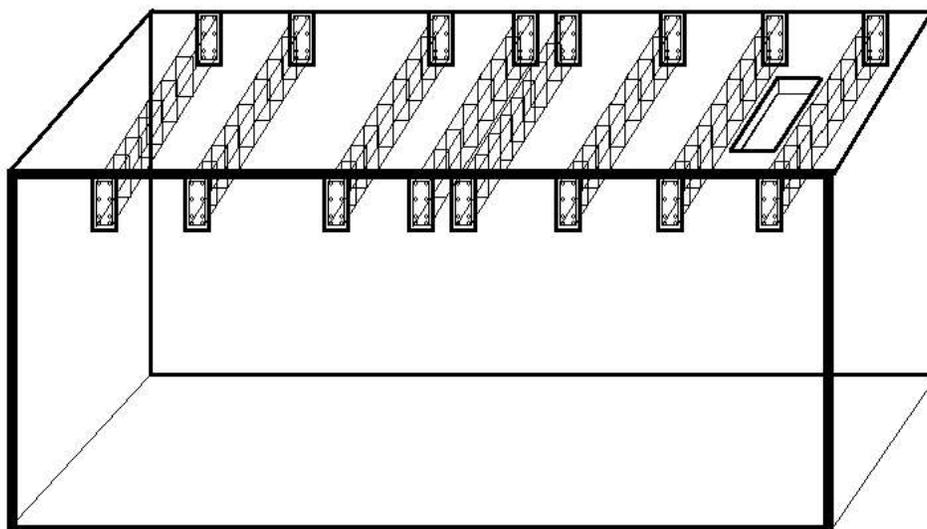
Isométrico de todas las vigas sobre ménsulas listas para cimbrado, (imagen propia).
